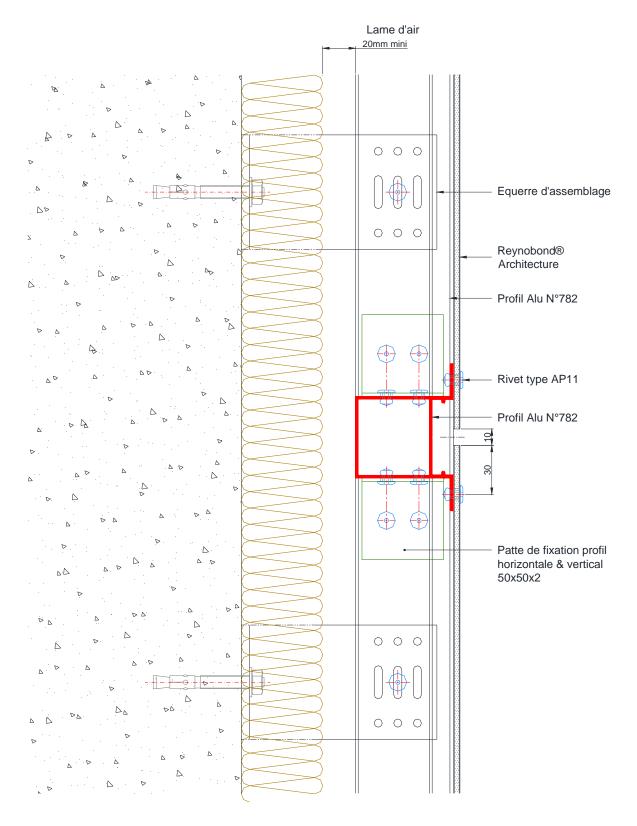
is – Joint horizontal - Coupe verticale - Système vissé SC 60 4c
